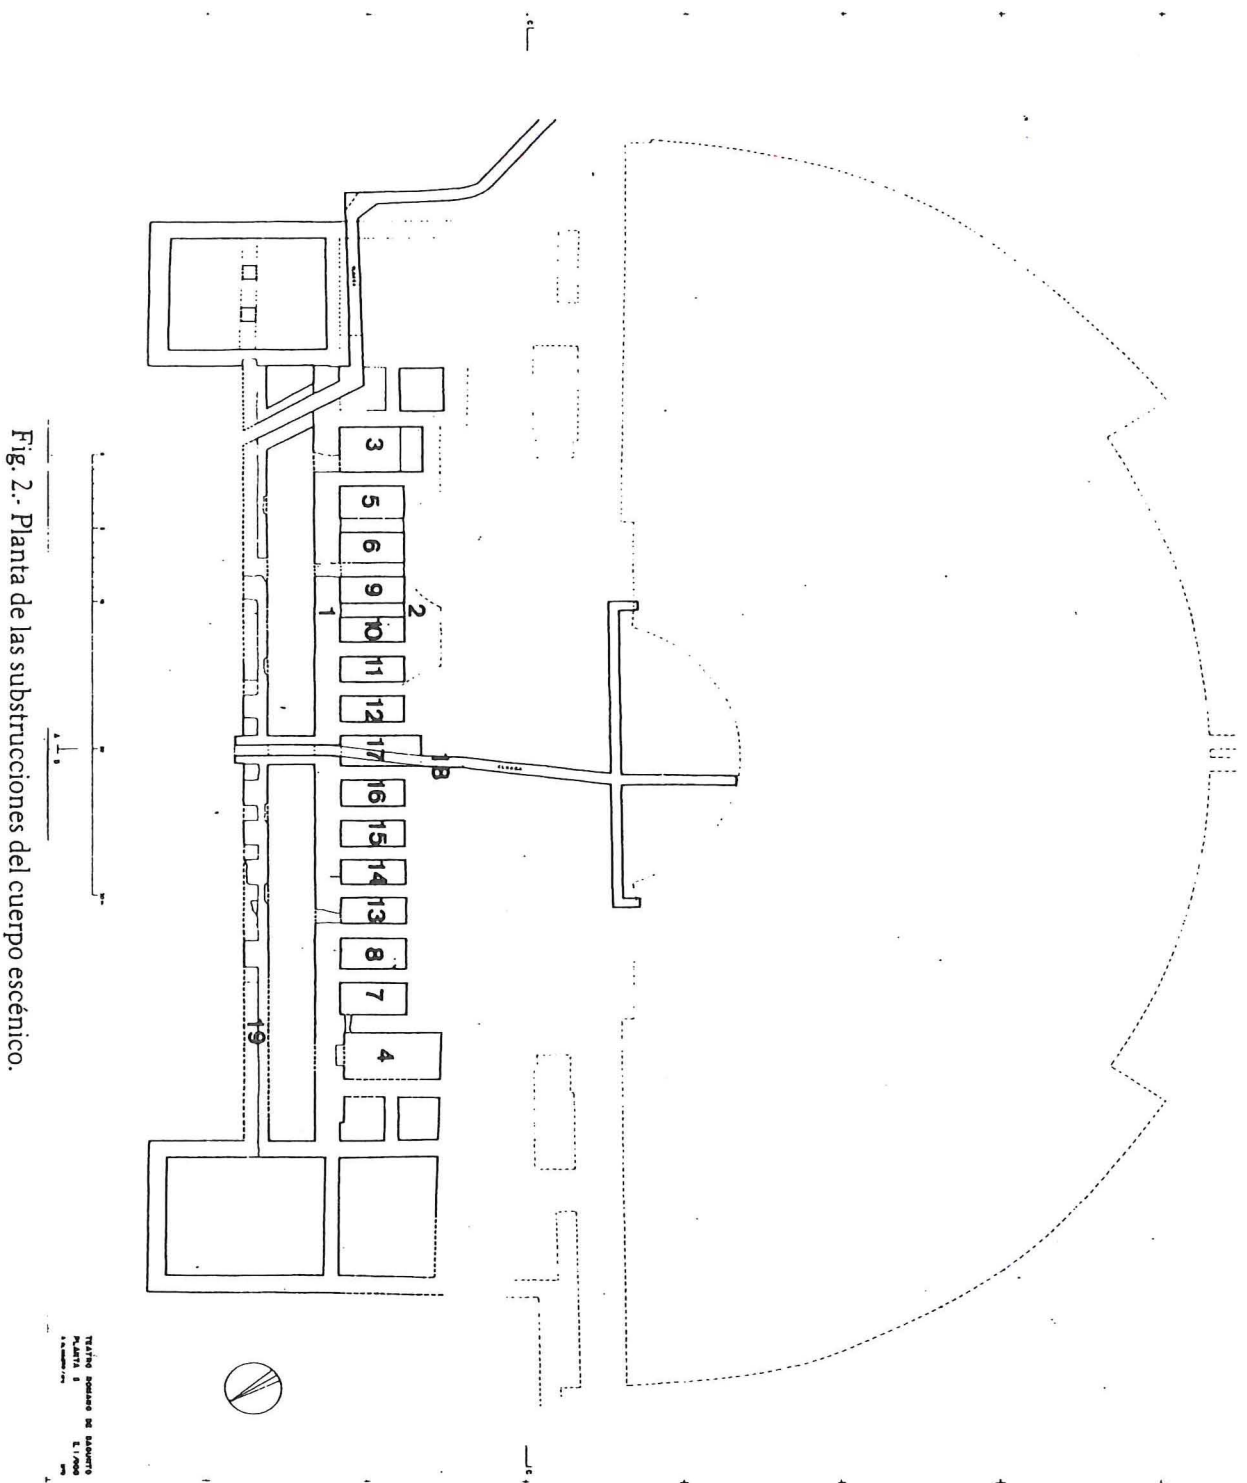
Planta de las subestructuras del cuerpo escénico.
